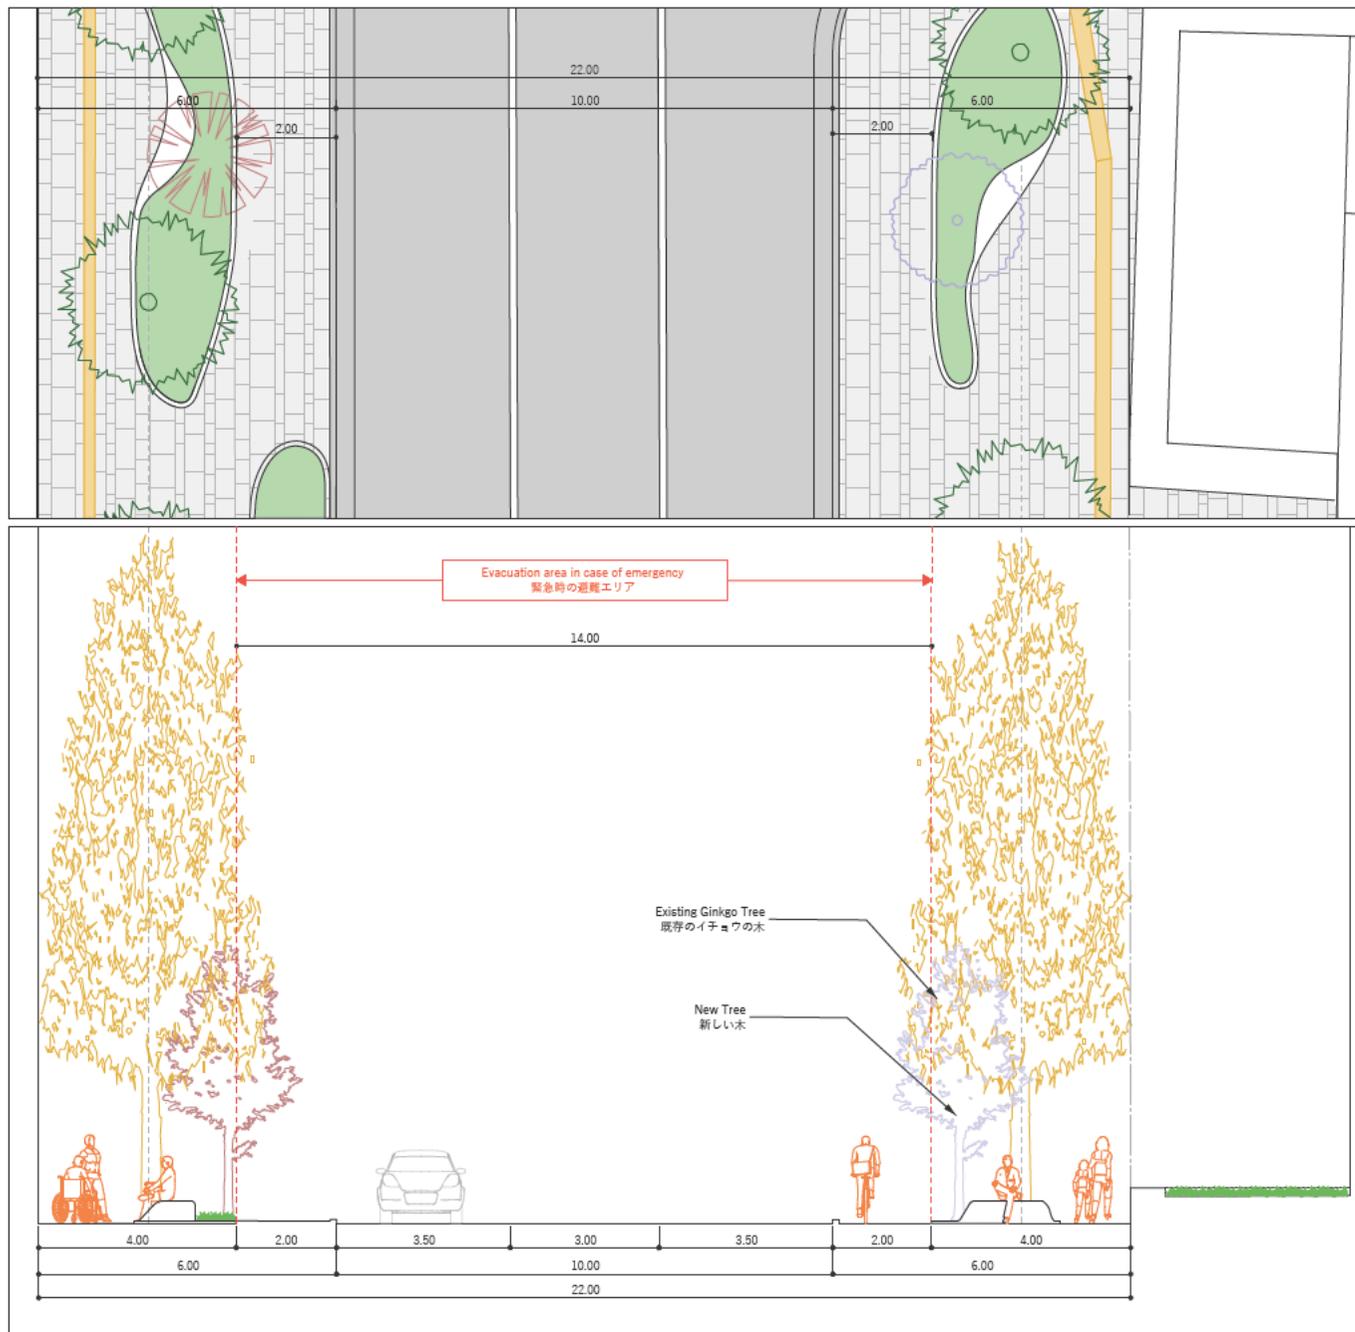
B案「四季の道」：詳細平面図（上）と横断図（下）
